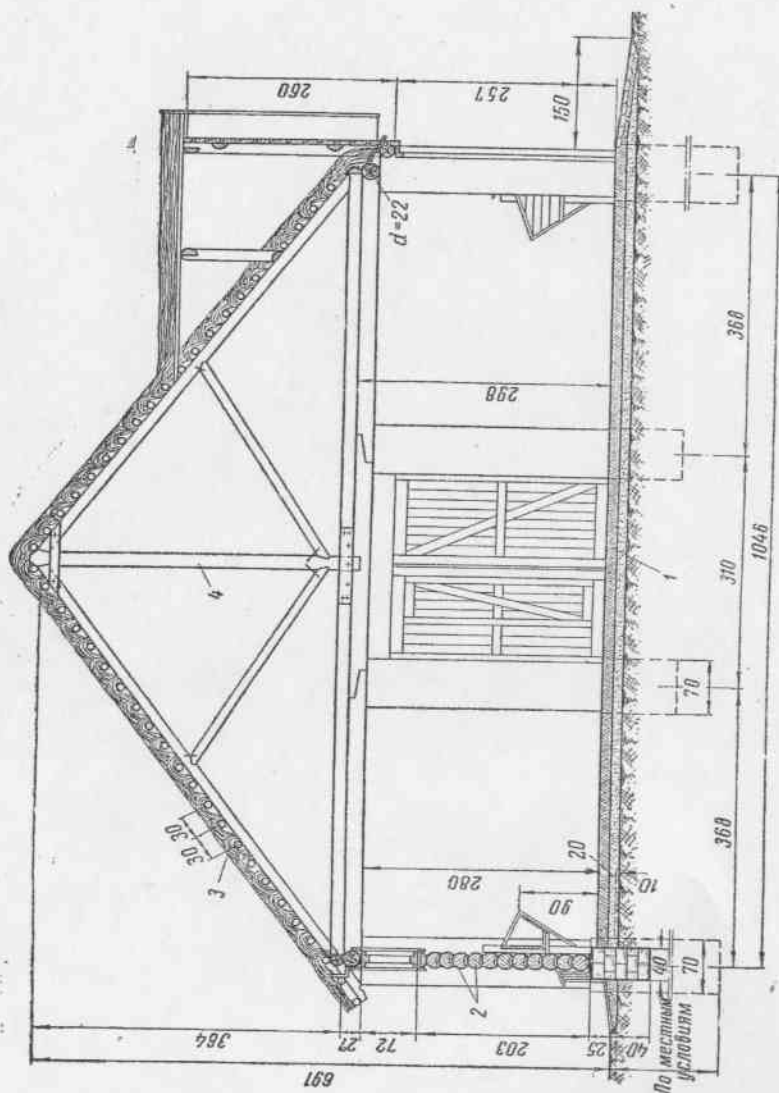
Поперечный разрез конюшни на 50 племенных маток табунного содержания: 1—пол из утрамбованной глины и утрамбованного грунта; 2—заборка из бревен; 3—крыша из глиносоломы или камыша под гребенку; 4—висячая ферма.
